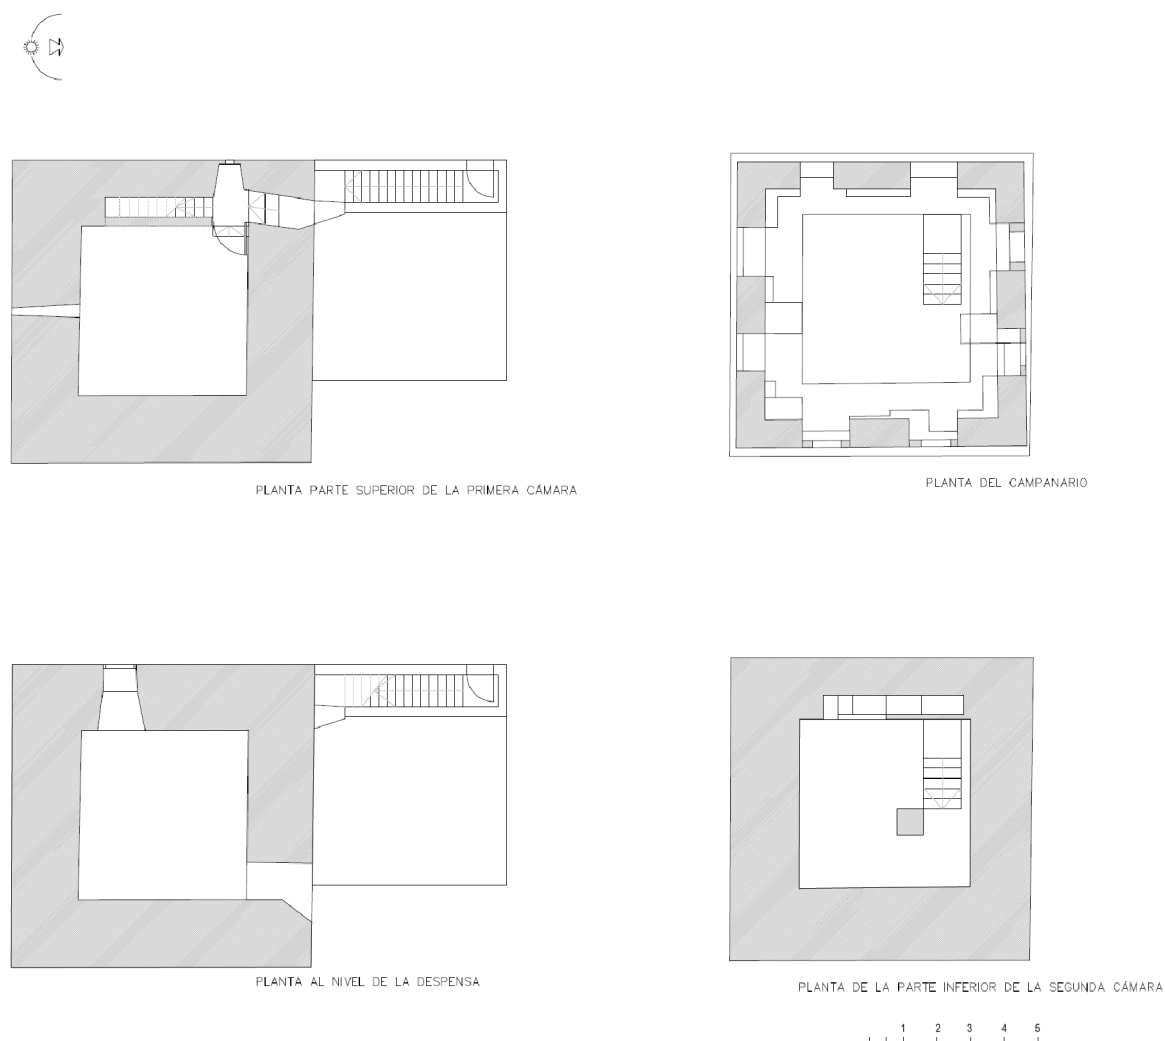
plantas del estado actual de la torre de Castellanos de Zapardiel.
